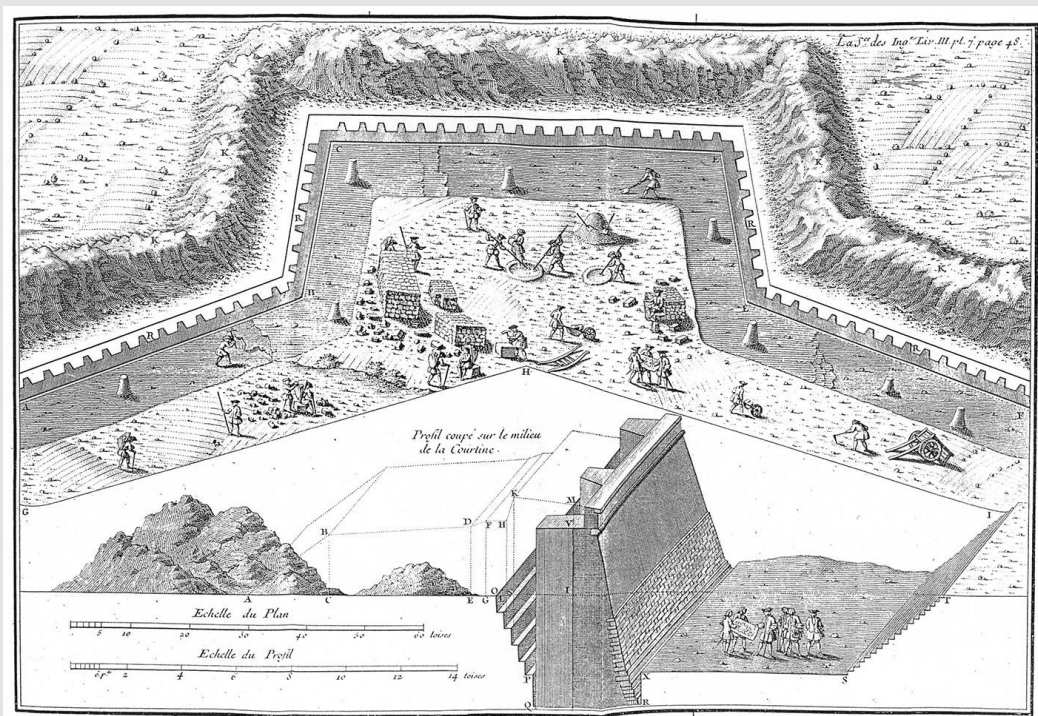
“Chantier de construction”, en el tratado de Belidor (1729: 48).
